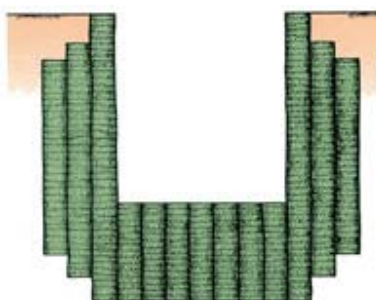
Contenção lateral de escavações e combate à sub-pressão de água [7]
